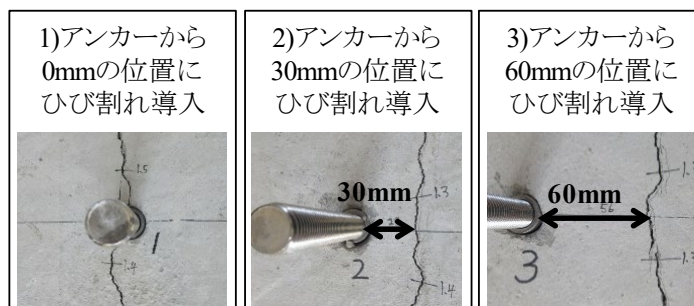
アンカー設置位置から離隔を取ったひび割れの導入状況
